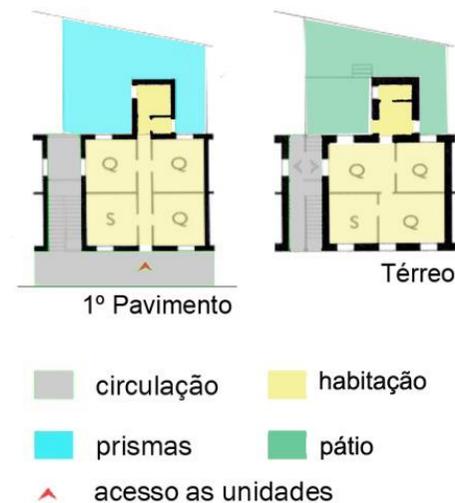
Reprodução da planta original. Fonte: Guia da Arquitetura Art Déco no Rio de Janeiro. Data: 10/2009.
